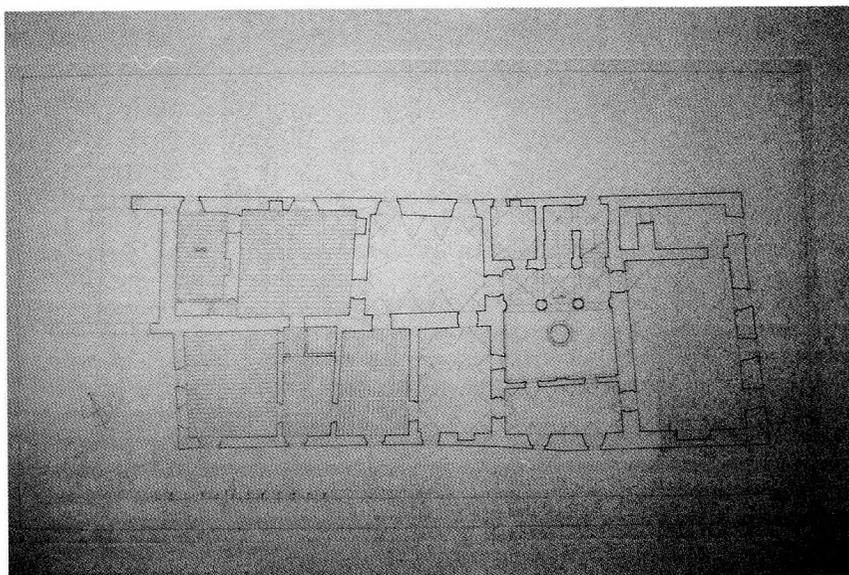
Pianta piano primo, *ante* ultimi interventi.
